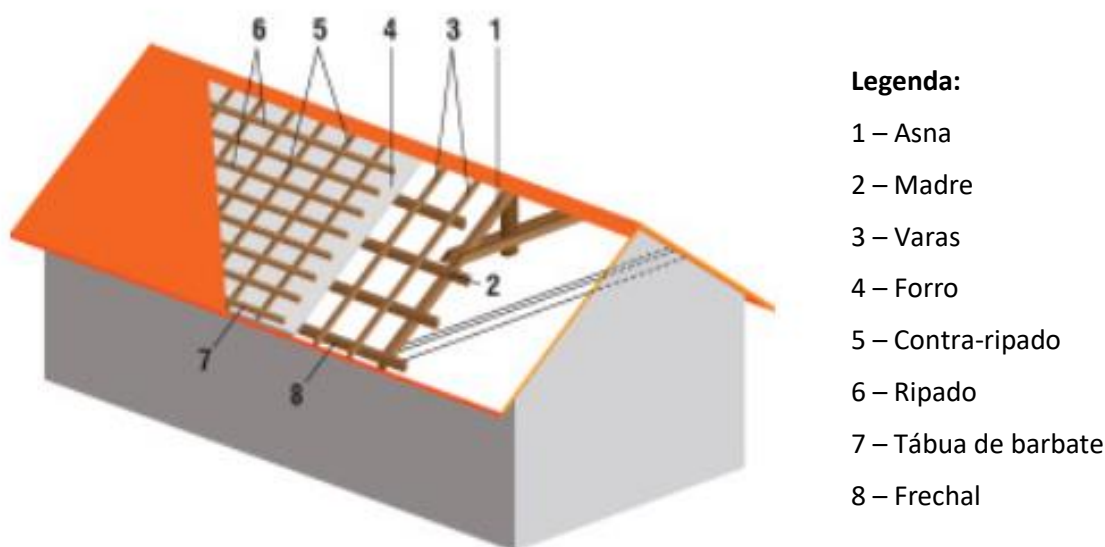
Esquema da estrutura de suporte de uma cobertura. Fonte: Cerâmica Torreense.
